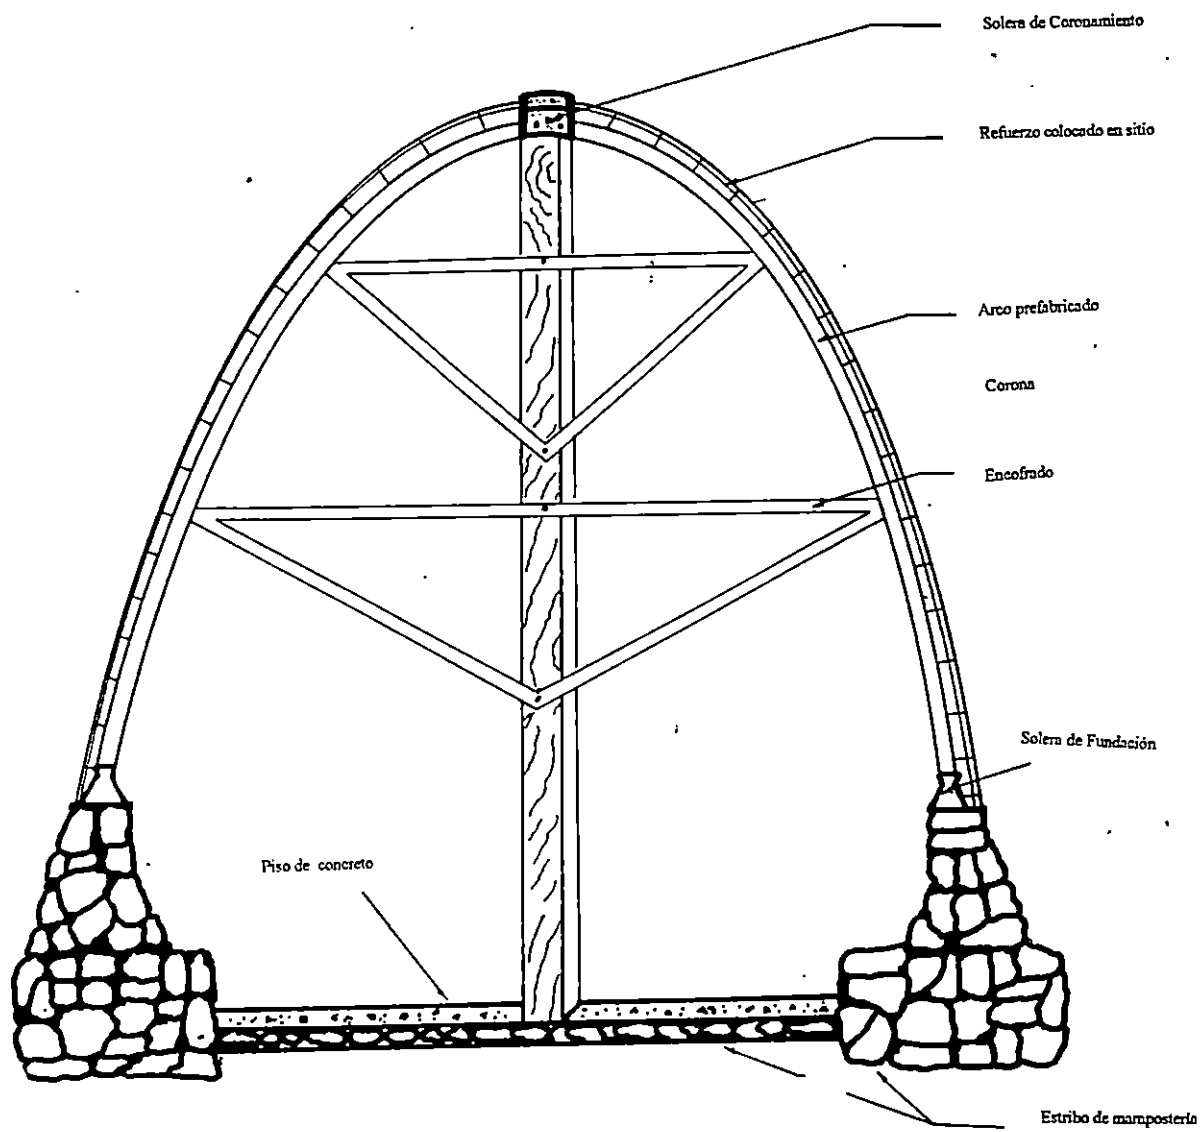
Muestra el encofrado empleado para la instalación de una bóveda prefabricada.
